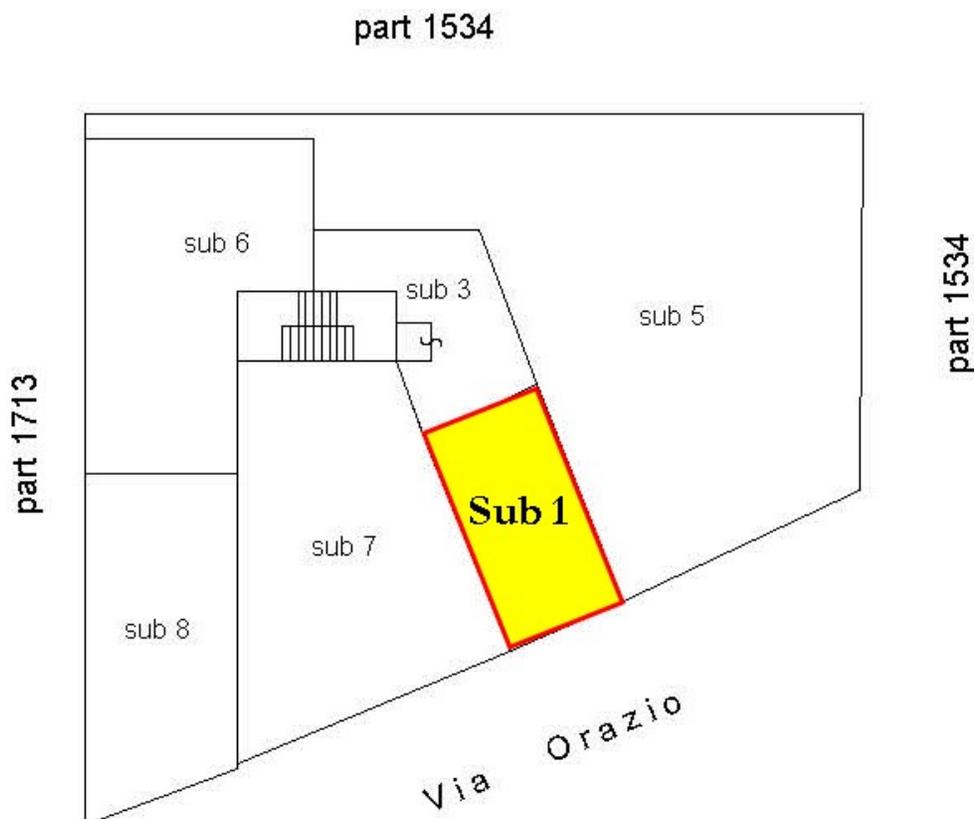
Elaborato planimetrico Piano Terra Particella 200
